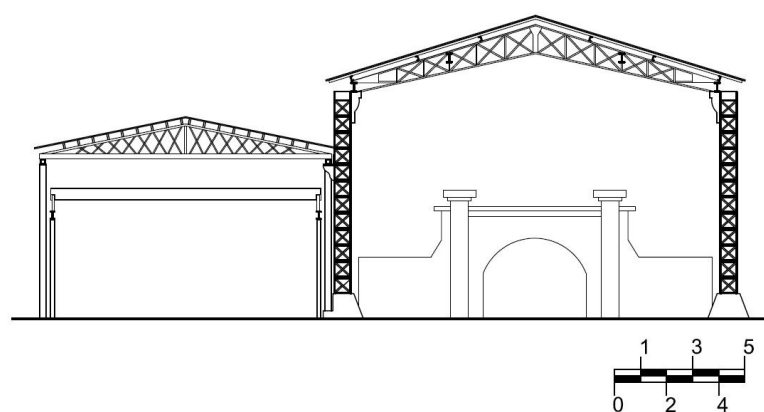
129: Ligação pilar metálico e estrutura ponte rolante - Galpão secundário - Boca da Mina.
